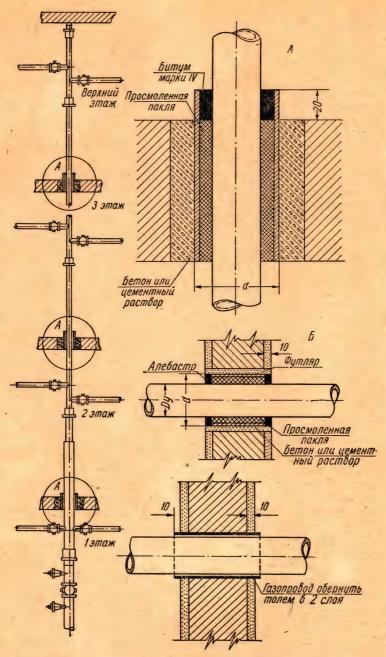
Лестничный стояк с двухсторонними отводами в квартиры: A — проход газопровода через лестничную площадку; B — проход газопровода через стены из пустотелого кирпича, шлакобетона и засыпные; B — проход газопровода через деревянные оштукатуренные, каменные и железобетонные стены.
